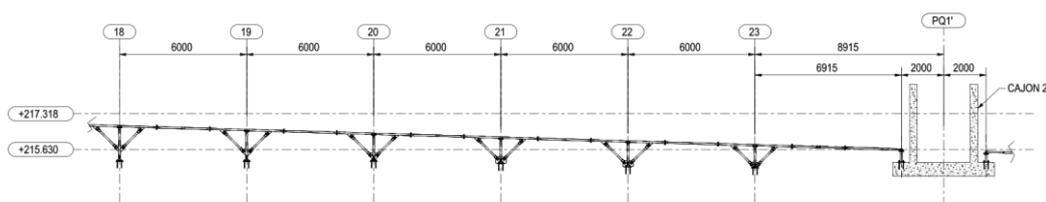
Soportería en tramo de soportes continuos (Corte cajón N°2)
